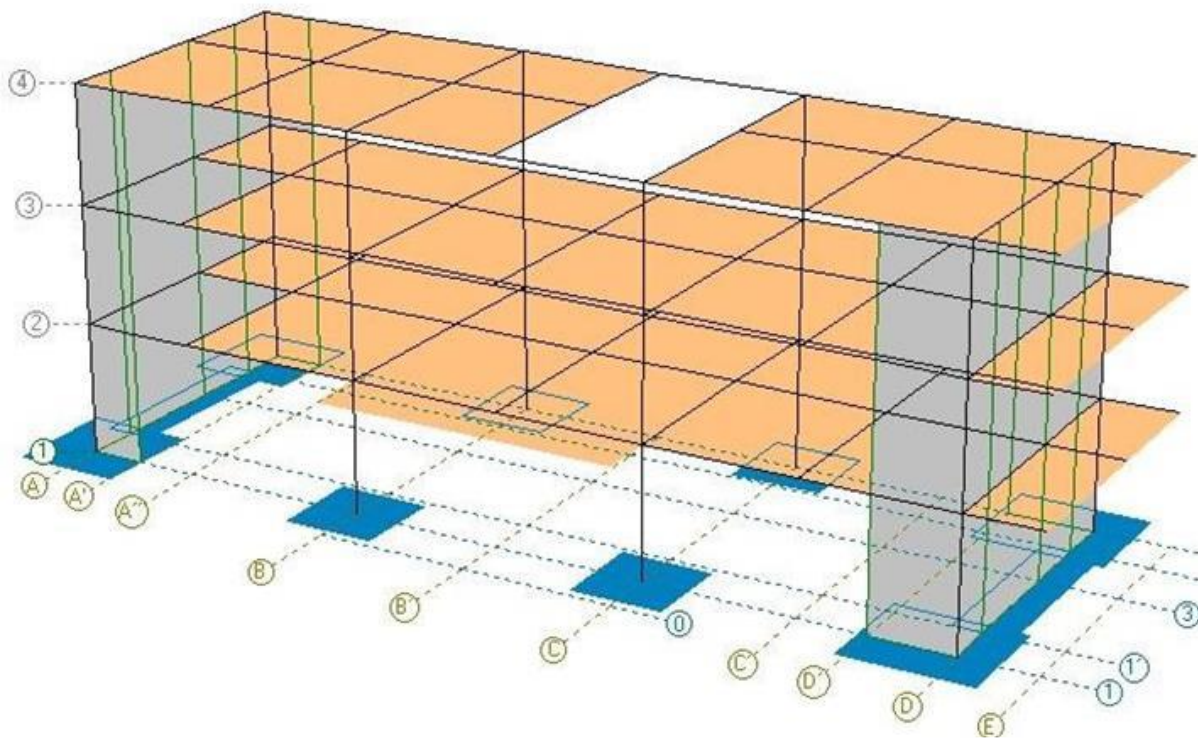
Pórtico con nuevo planteamiento estructural. Elaborada por el autor.
